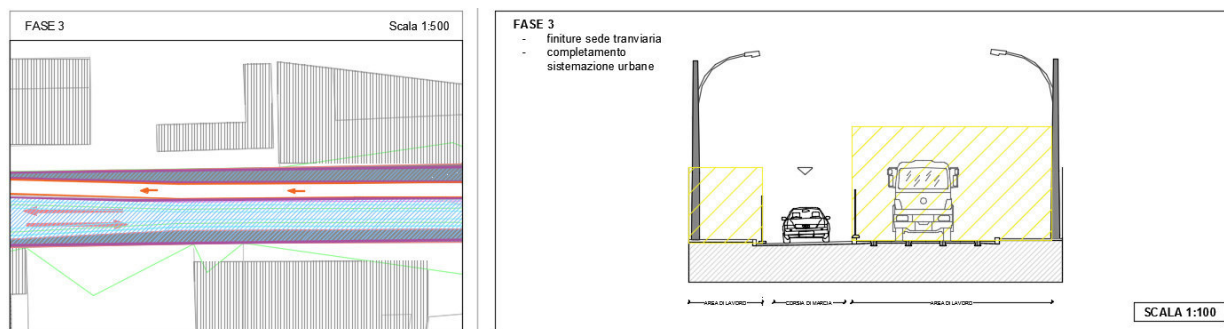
Tipologico cantiere con sede laterale Fase 3
